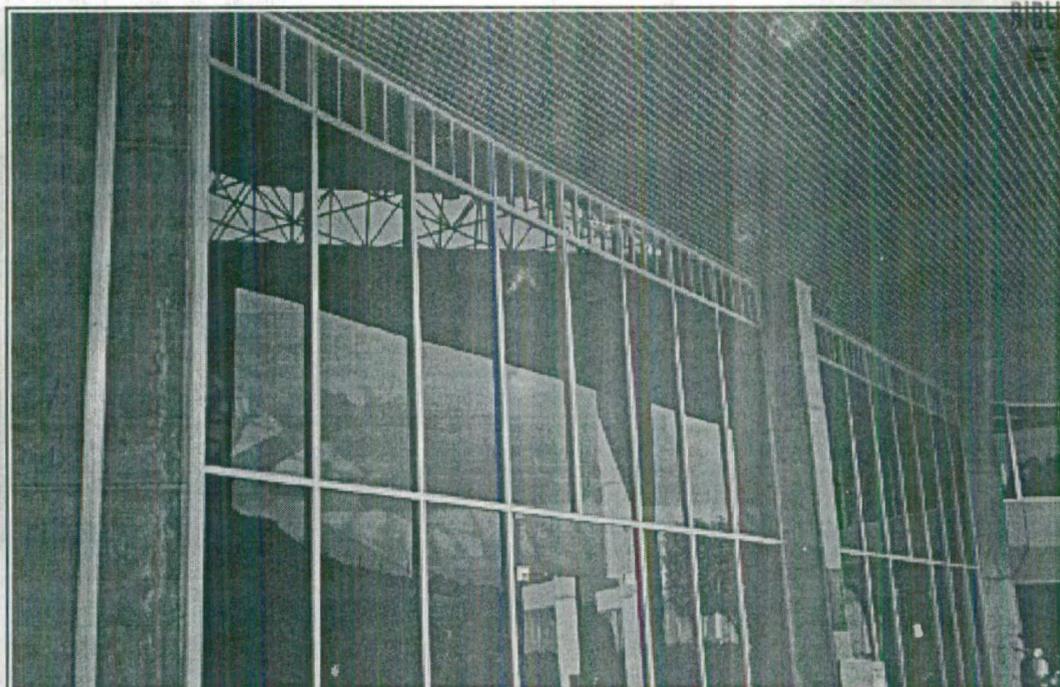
Vista de pasamanos de madera y vidrio, piso de marmettone y áreas con recubrimiento de hormigón visto
